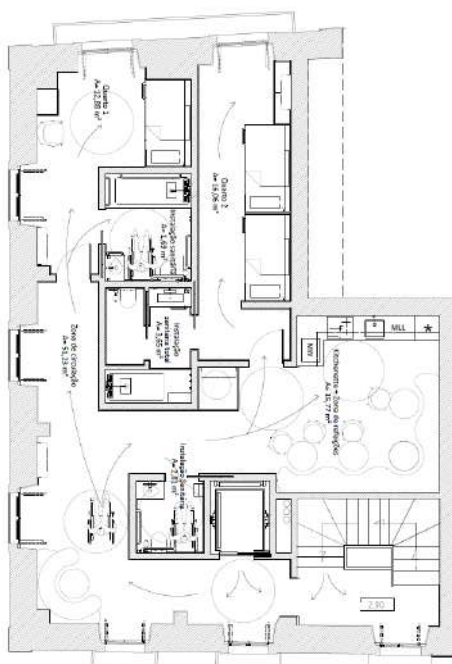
Planta de Zonamento e Circulação - Piso 1
